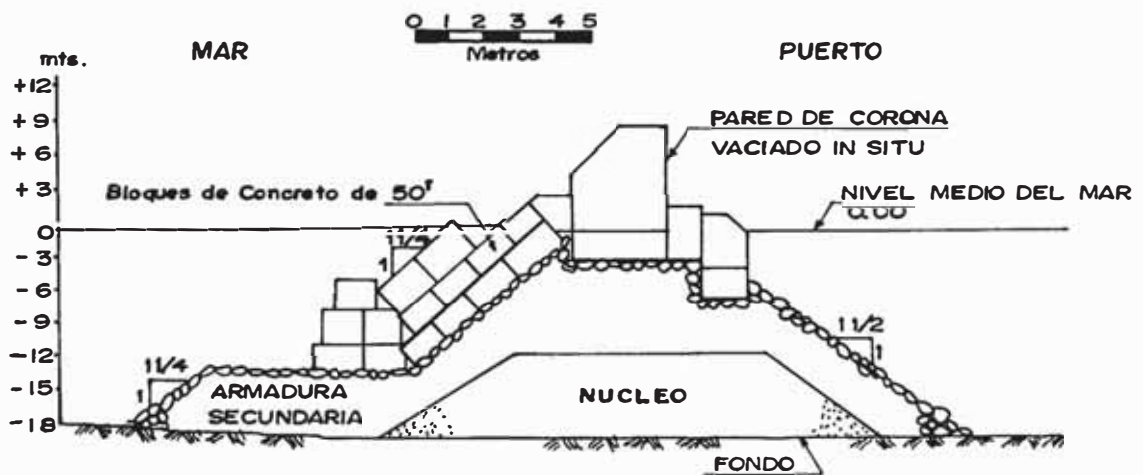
ROMPEOLAS ARMADO CON BLOQUES DE CONCRETO MONTADOS DE FORMA ORDENADA
